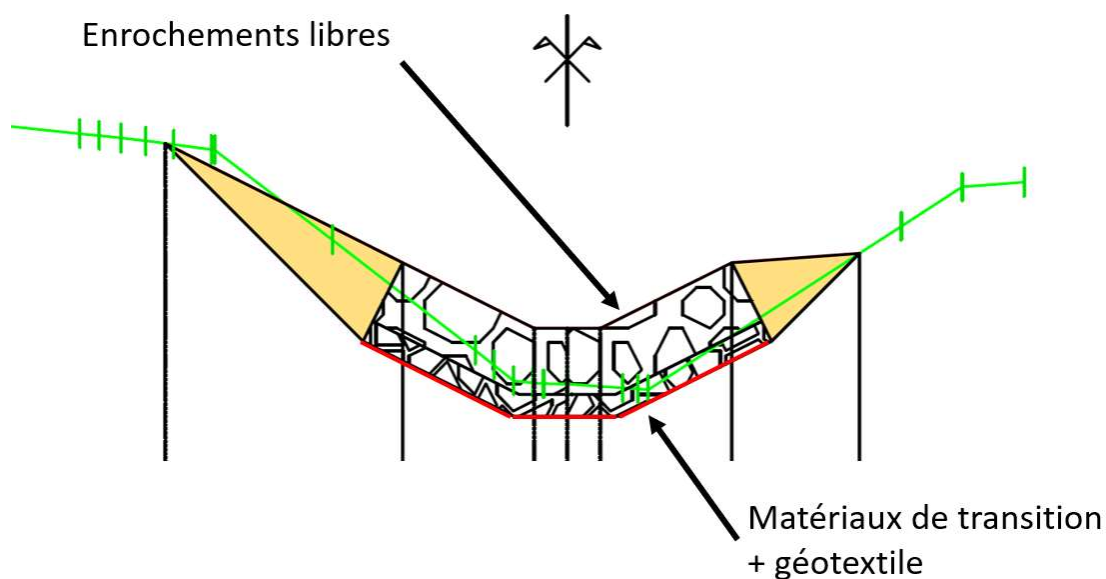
Coupe type du ruisseau avec berges de pente 2(H)/1(V) et protection en enrochements libres
